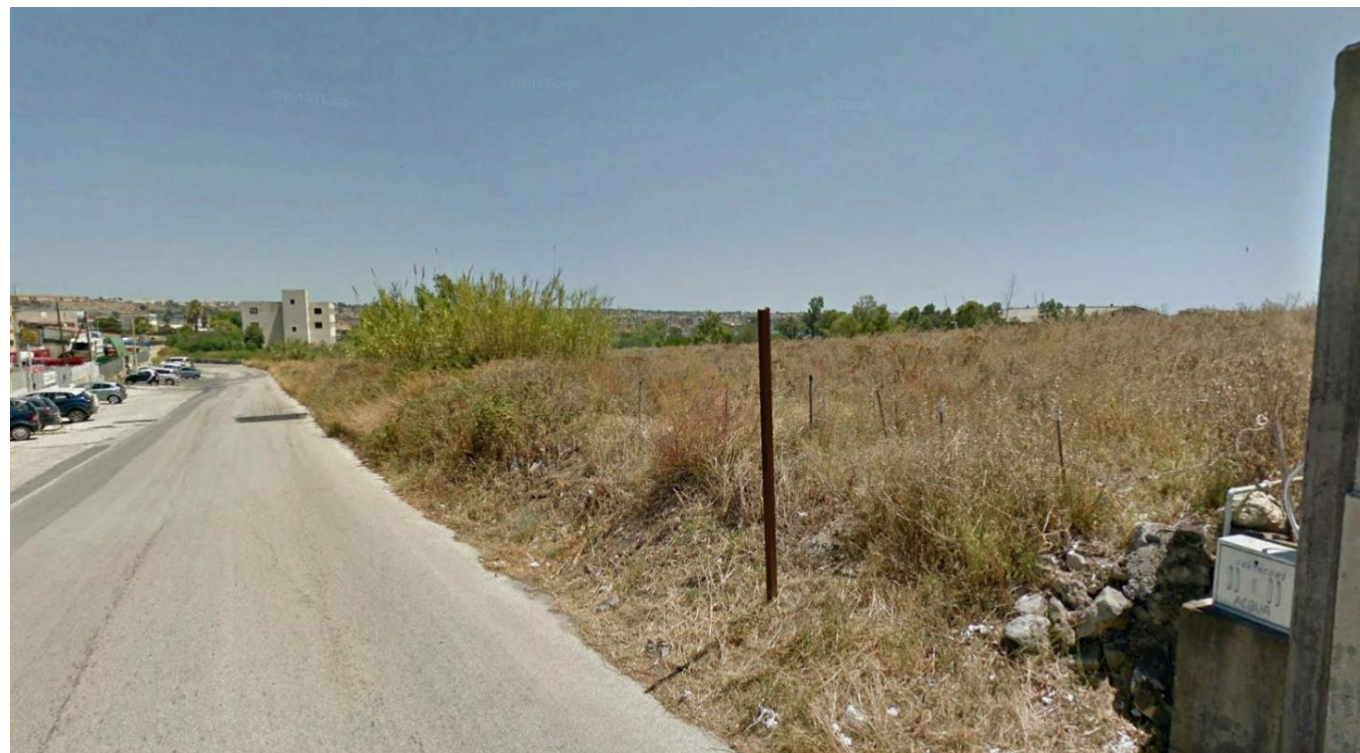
Aree di Cantiere Fisso AT.04 - CO.02 Ambito Piana Costiera
